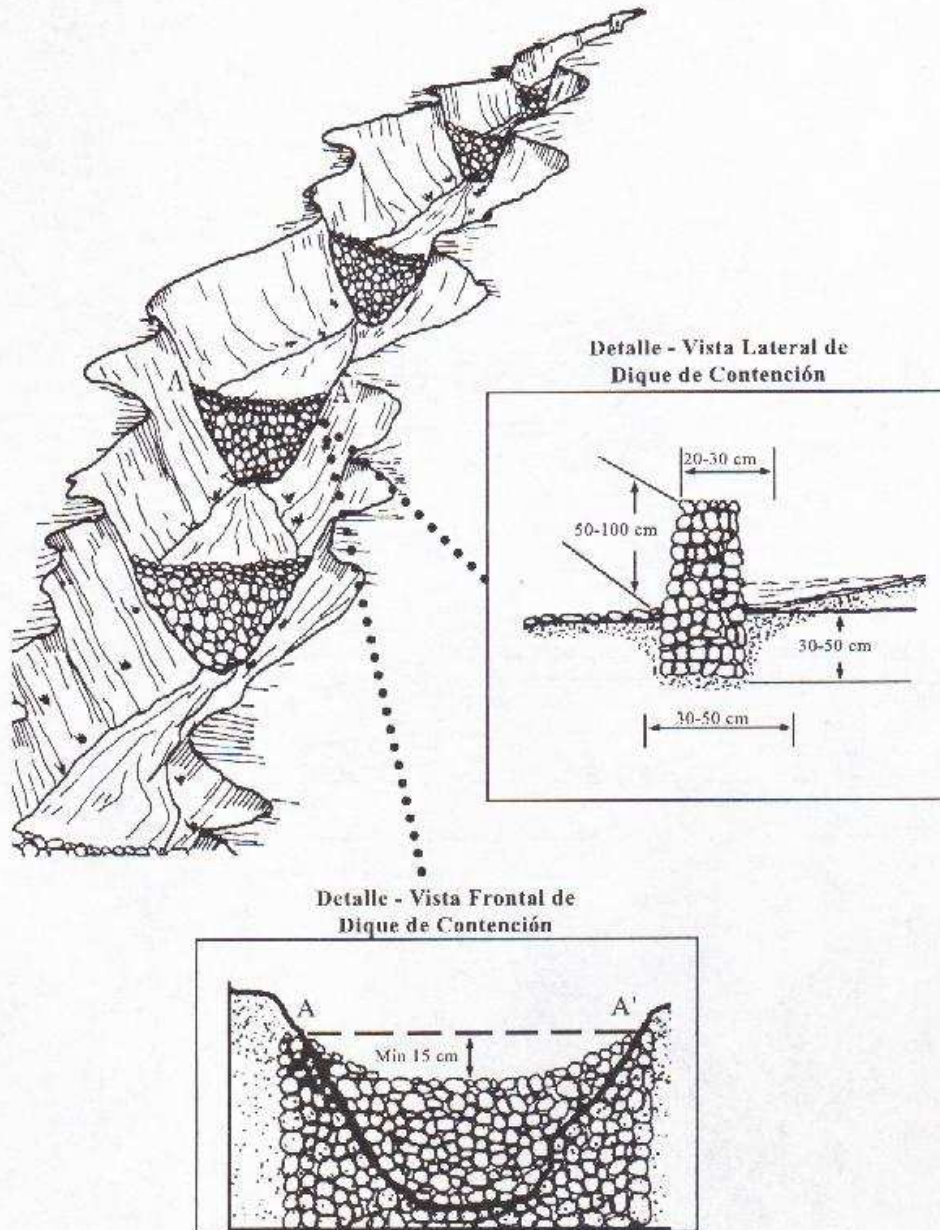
Características de los diques de contención hechos con piedras o mampostería.
